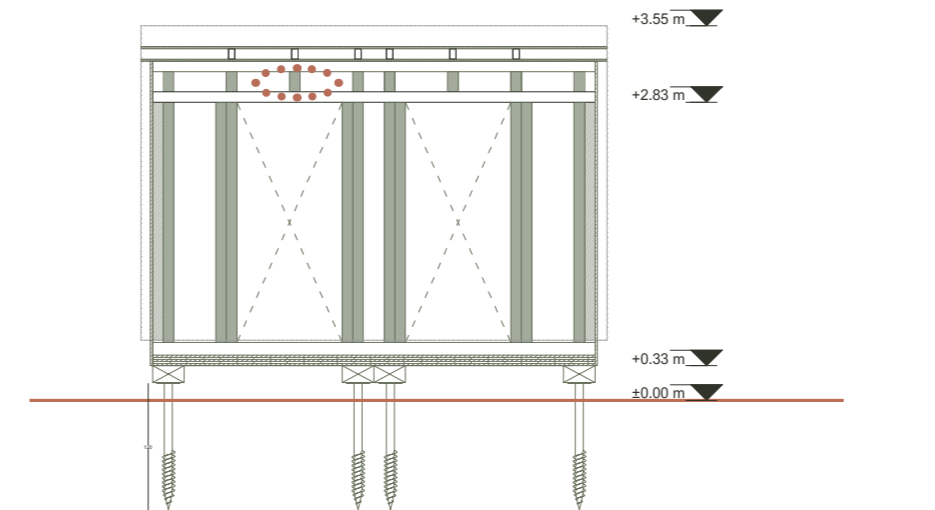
Sezione modulare strutturale - verifica travetto centrale tetto
